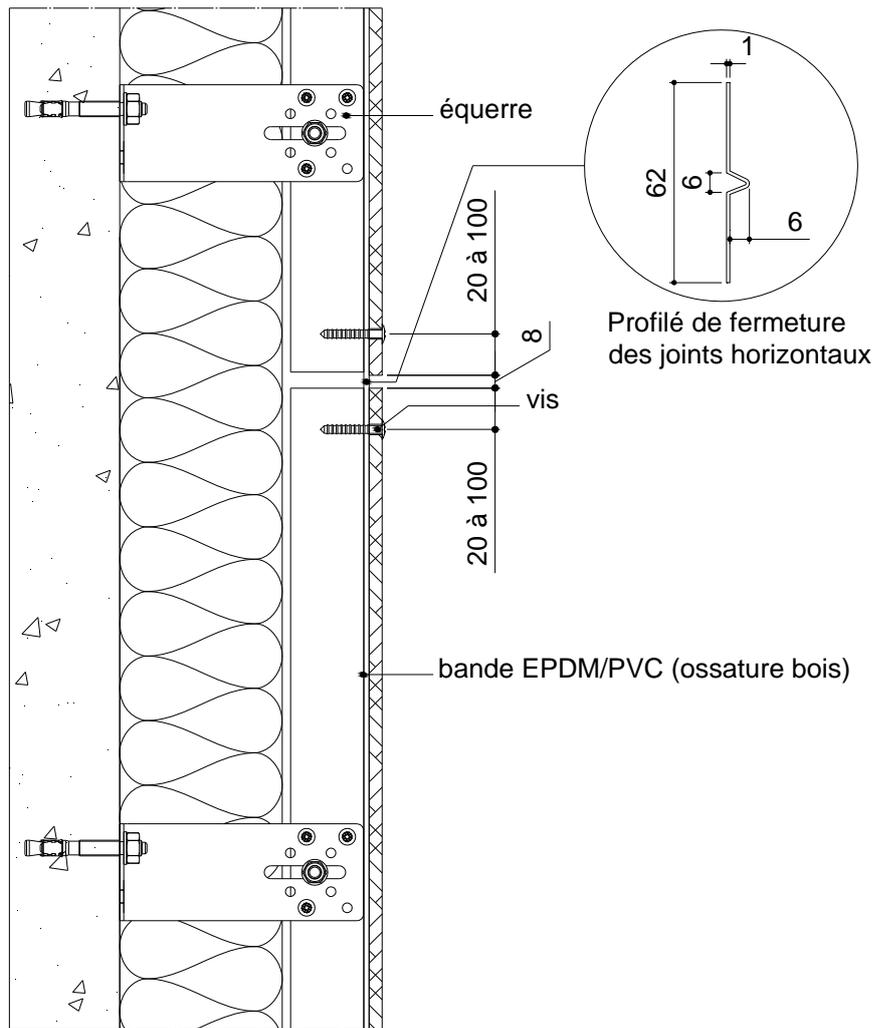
Joint horizontal (coupe verticale) sur ossature bois ou métallique (cote en mm)
